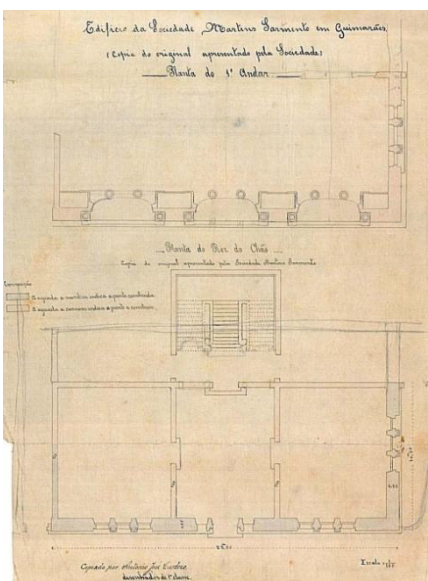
Planta dos pisos a manter da primeira fase de construção, Sociedade Martins Sarmento
